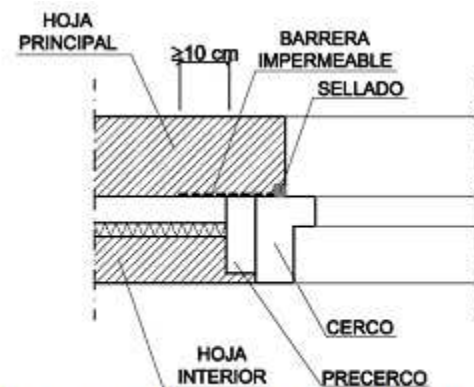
Ejemplo de encuentro de la fachada con la carpintería
